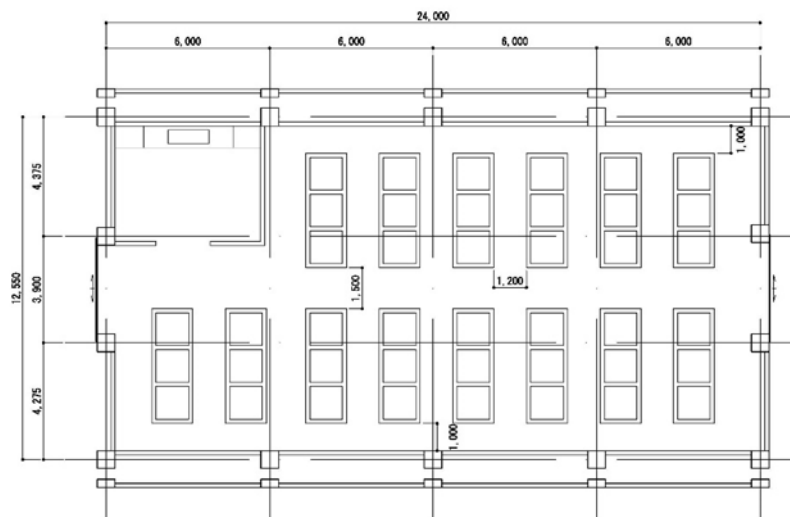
Plan du hangar de fumage de poisson (pour un bâtiment)
